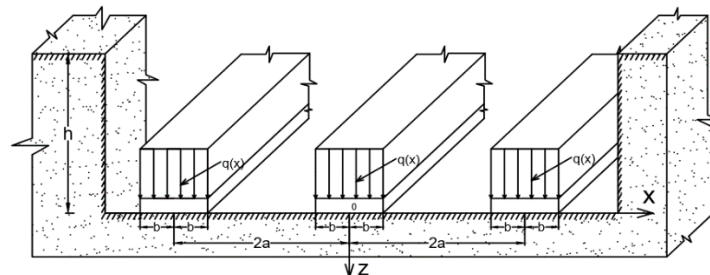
Схема действия нагрузки от стен подземных сооружений на грунтовые основания через ленточные фундаменты
